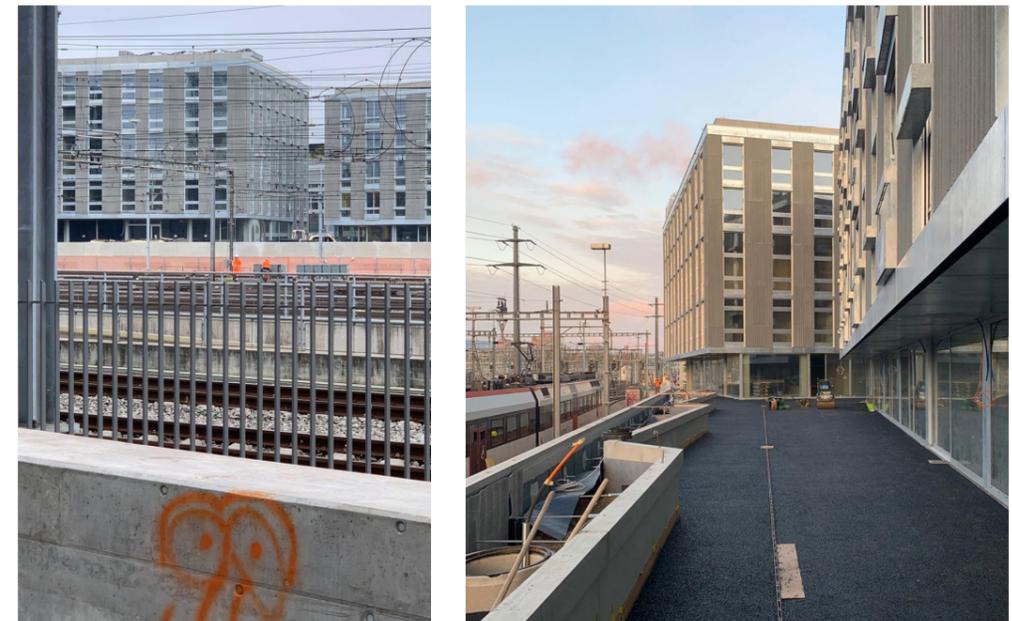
, 92 e 93 Fotos externas do complexo de Zollhaus - ilustrando a fachada e a relação estabelecida entre a construção e os trilhos de trem (2020)
